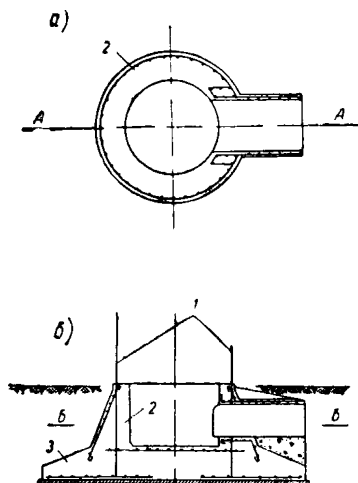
Фундамент под железобетонную дымовую трубу с подземным вводом газохода
